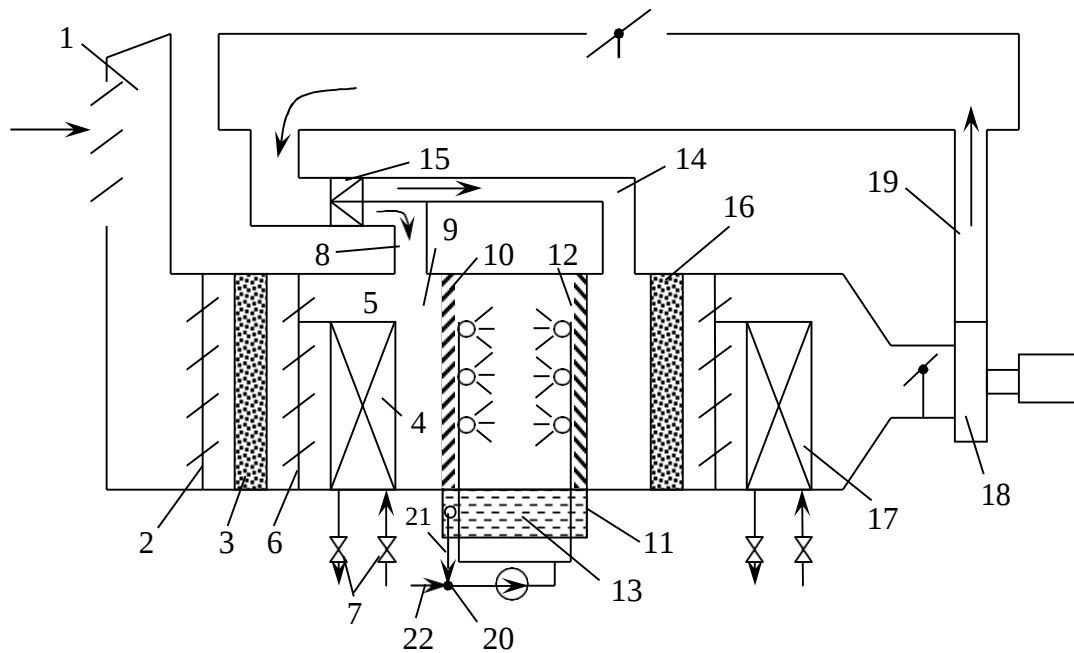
Принципова схема форсункового кондиціонера з двома рециркуляціями
